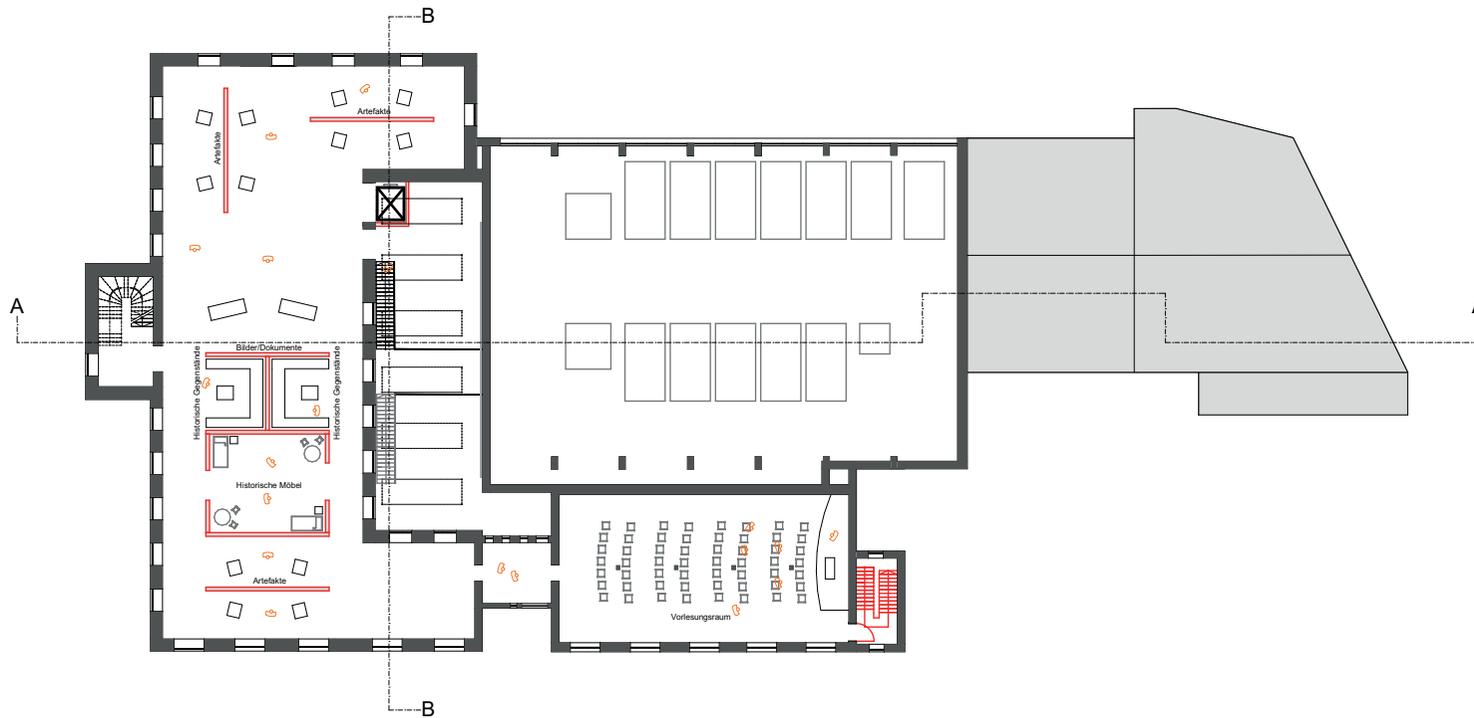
Grundriss 2.OG M 1 : 500
